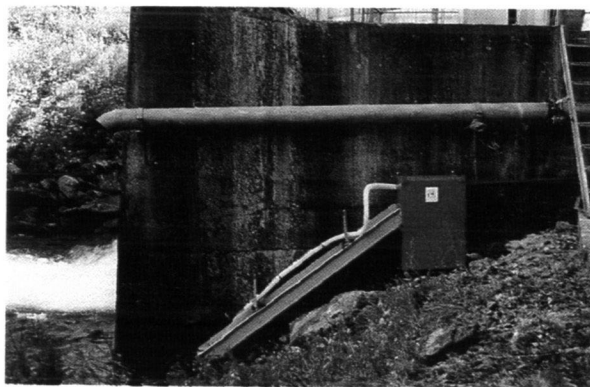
Passe-piège à anguilletes au barrage de la Ville-Hatte sur l'Arguenon (Côtes-d'Armor).
